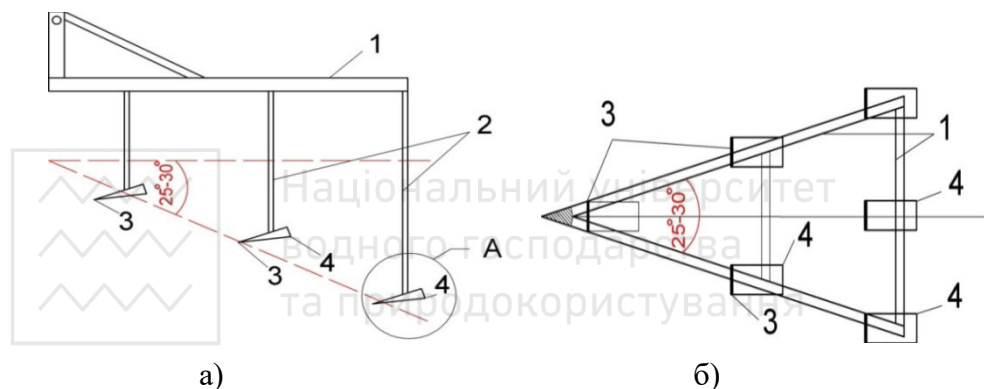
Багаторушній розпушувач для підвищення підґрунтової фільтрації: а) вигляд збоку; б) вигляд зверху; А – ґрунторозробний елемент; 1 – рама; 2 – стояк; 3 – леміш; 4 – ґрунторозпушувальна поверхня
